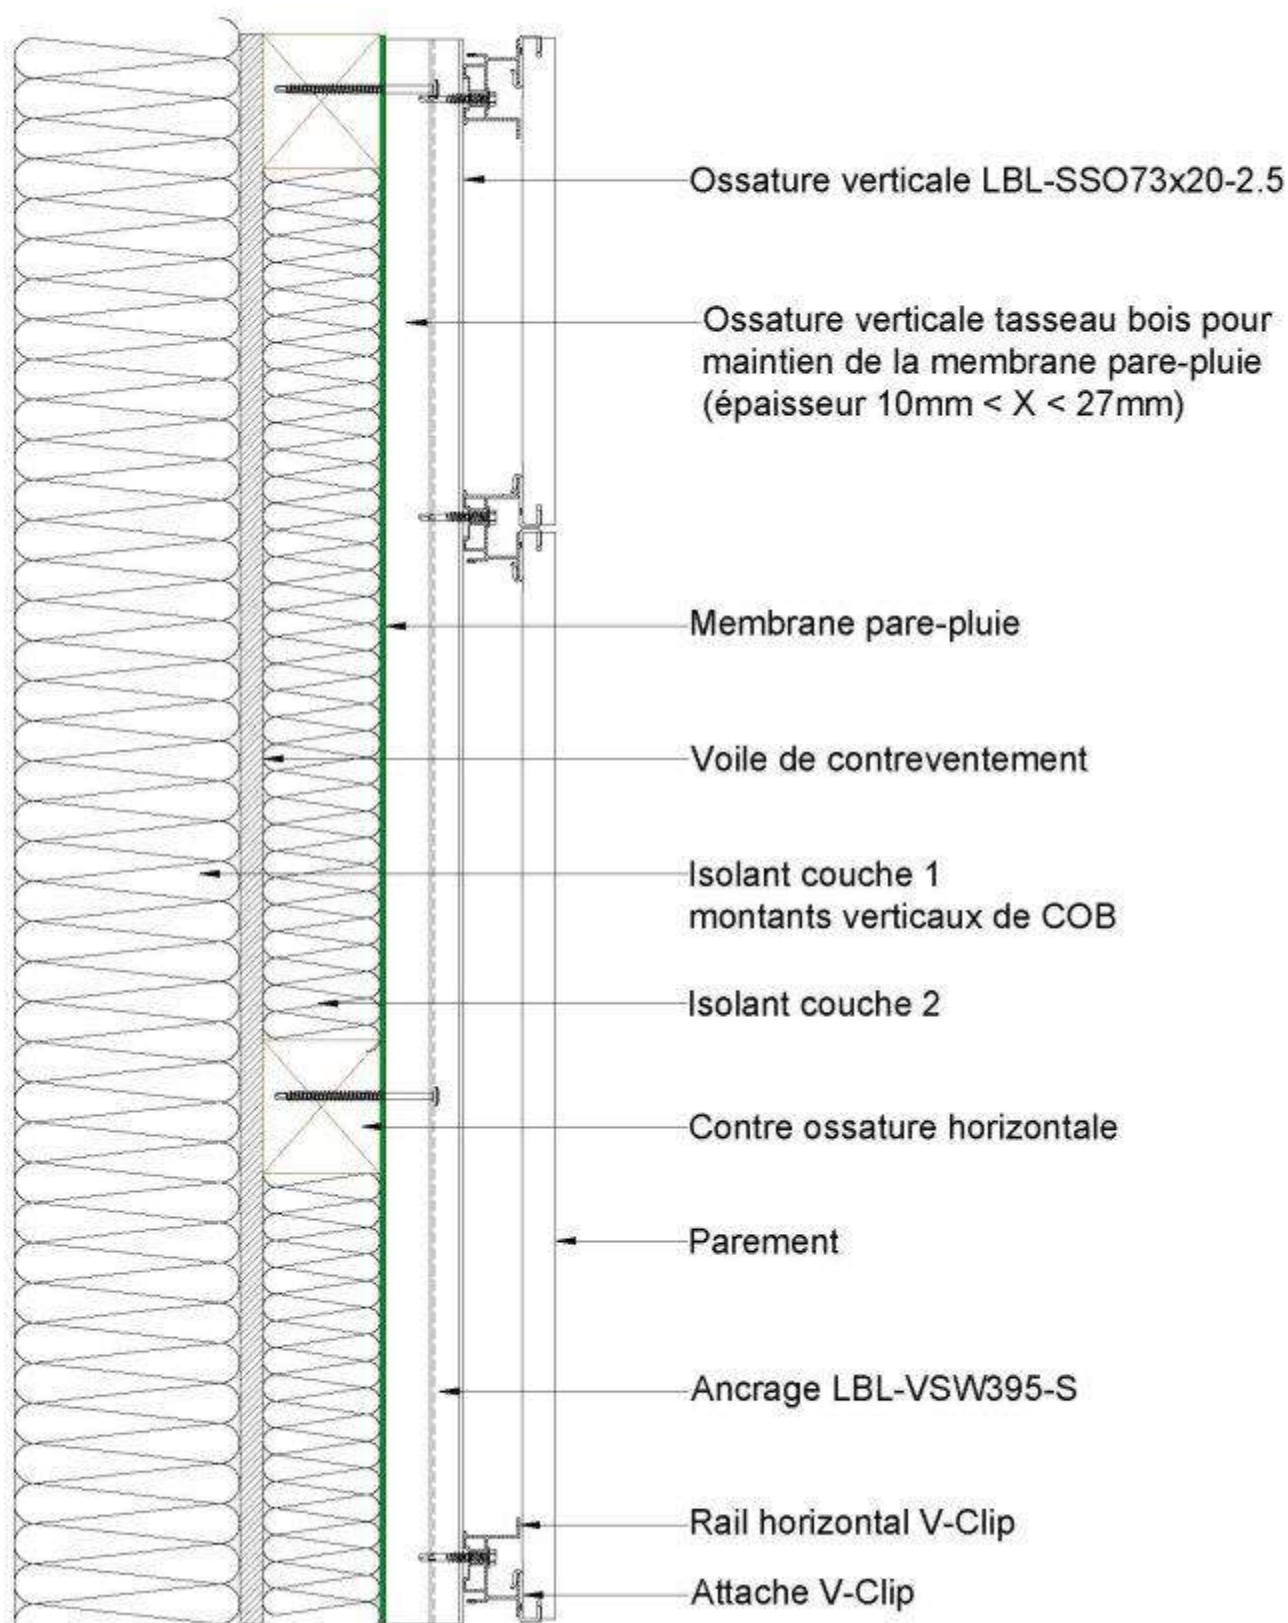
Coupe verticale COB avec complément d'isolation extérieur conforme au NF DTU 31.2
